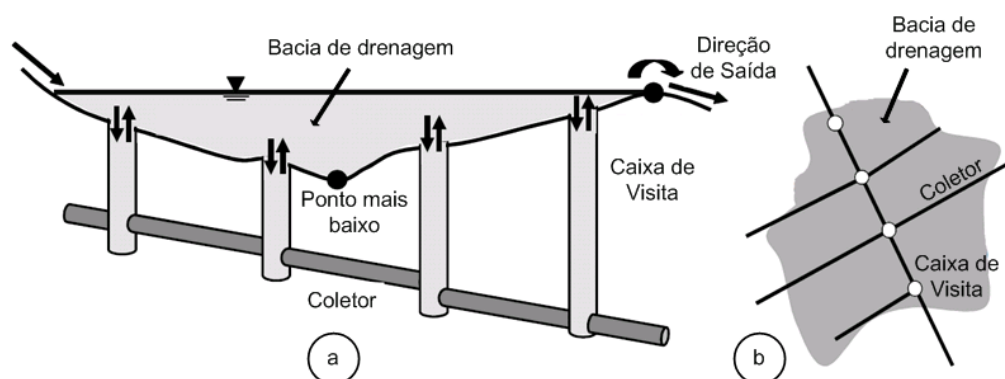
Interação entre o escoamento em coletores e a bacia de drenagem: a) vista em perfil; b) vista em planta (Adaptado de Maksimovic et al., 2009)
